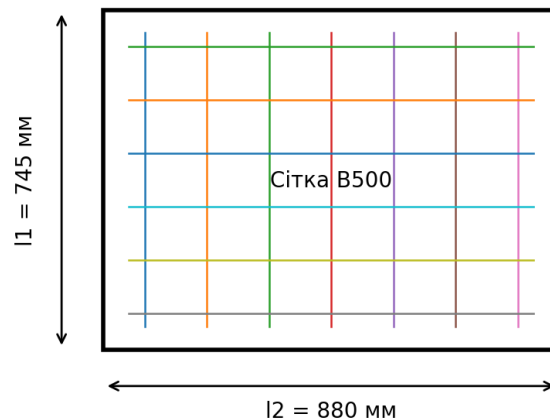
Схема роботи та армування плити сходового майданчика
